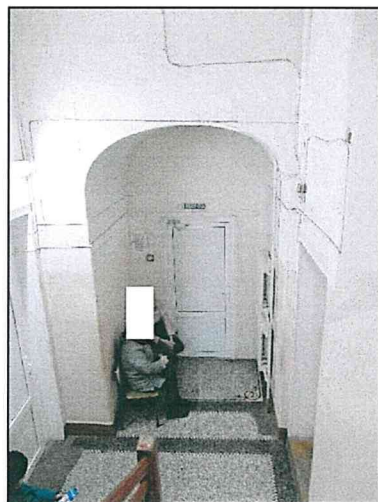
, 97. Первый этаж северной части объекта. Конструкции стен, перекрытий. Конструкции пола.
